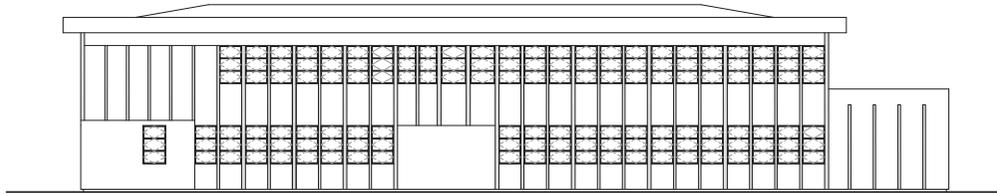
FACHADA NORTE Fonte: desenho da autora.
